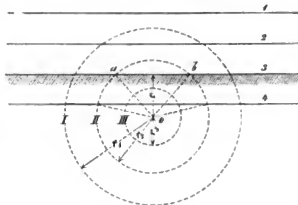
Mit Schwarzpulver geladenes Bohrloch.
